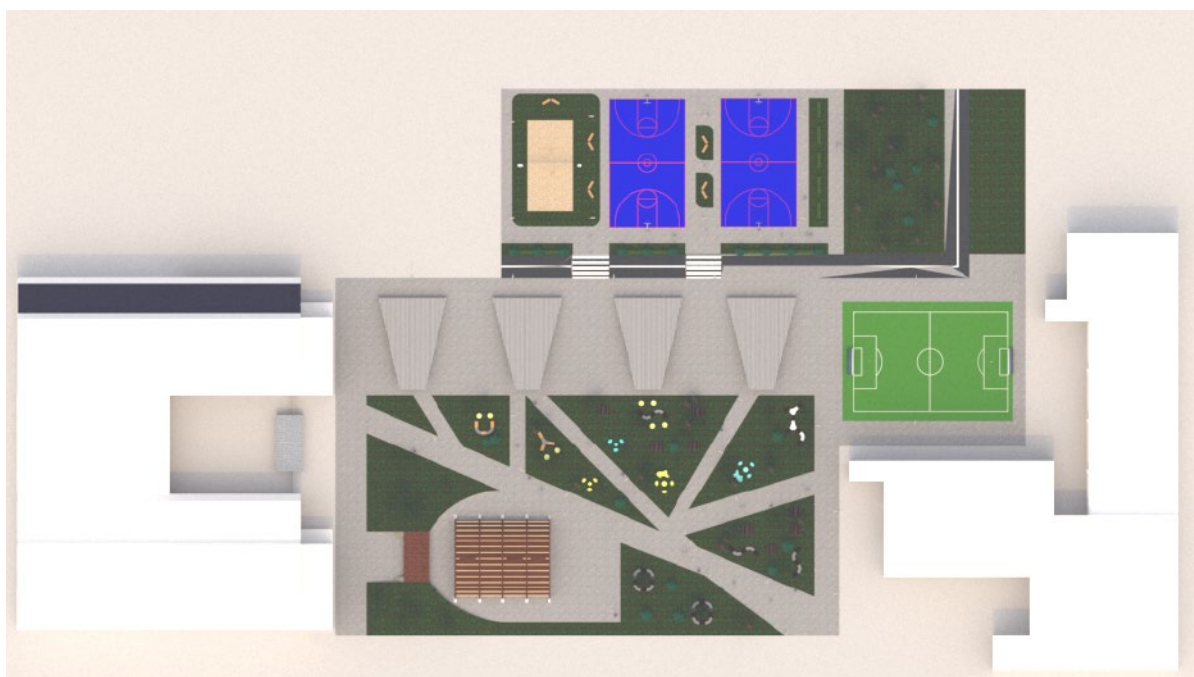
Render final de la planta de la Plaza de las Ingenierías
